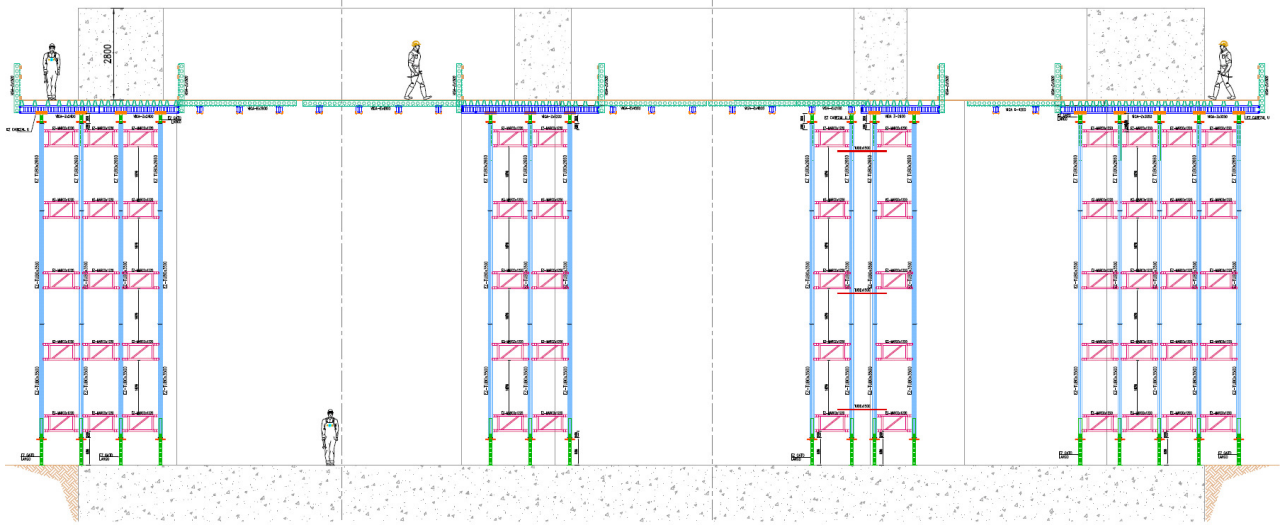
Corte transversal de estructura de hormigón armado para turbina.
